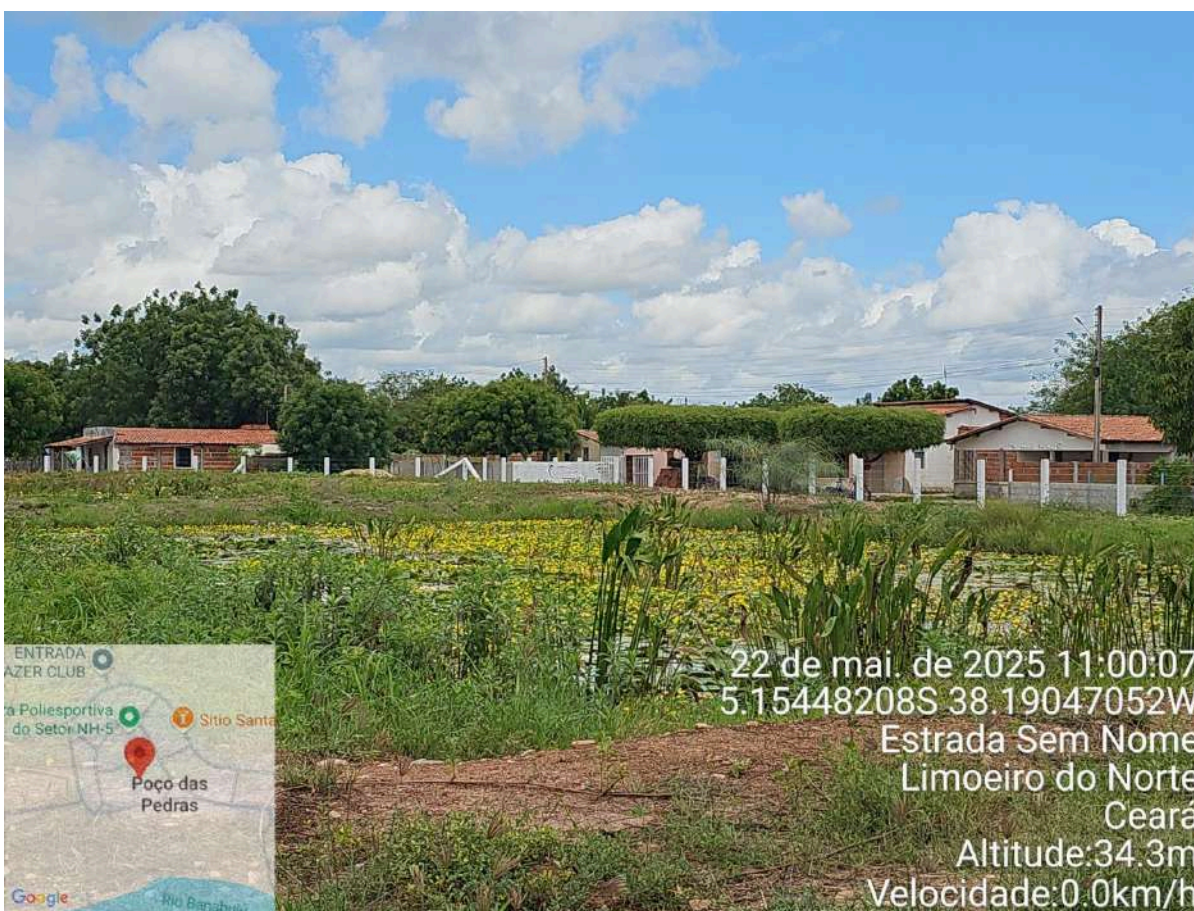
Tanque de remoção de ferro - ETA Setores.
